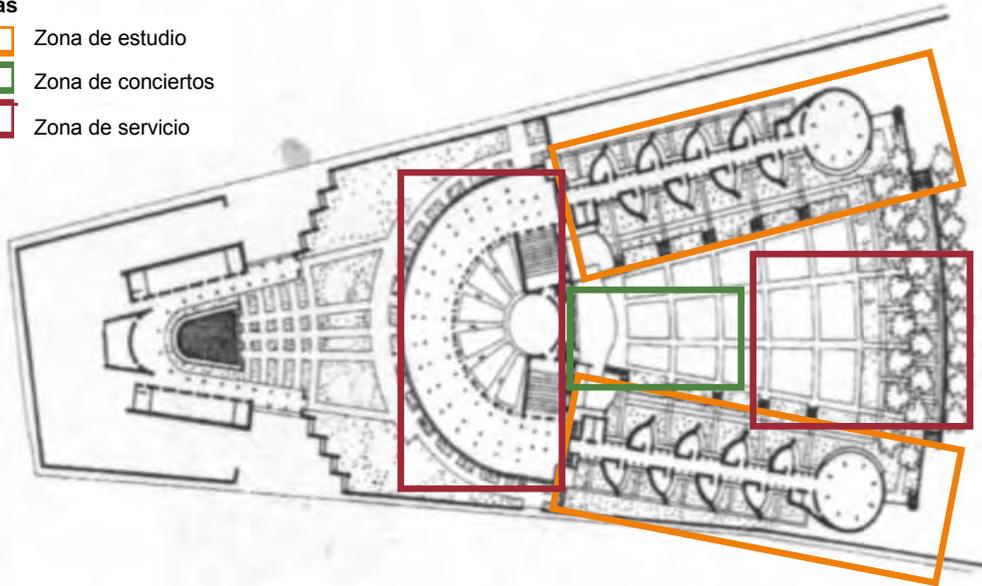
, Planta Arquitectónica, Conservatorio Nacional de Música. Fuente: Presentación, M. Arq. Alma Rosa Rodríguez López, consulta 05/11/12
